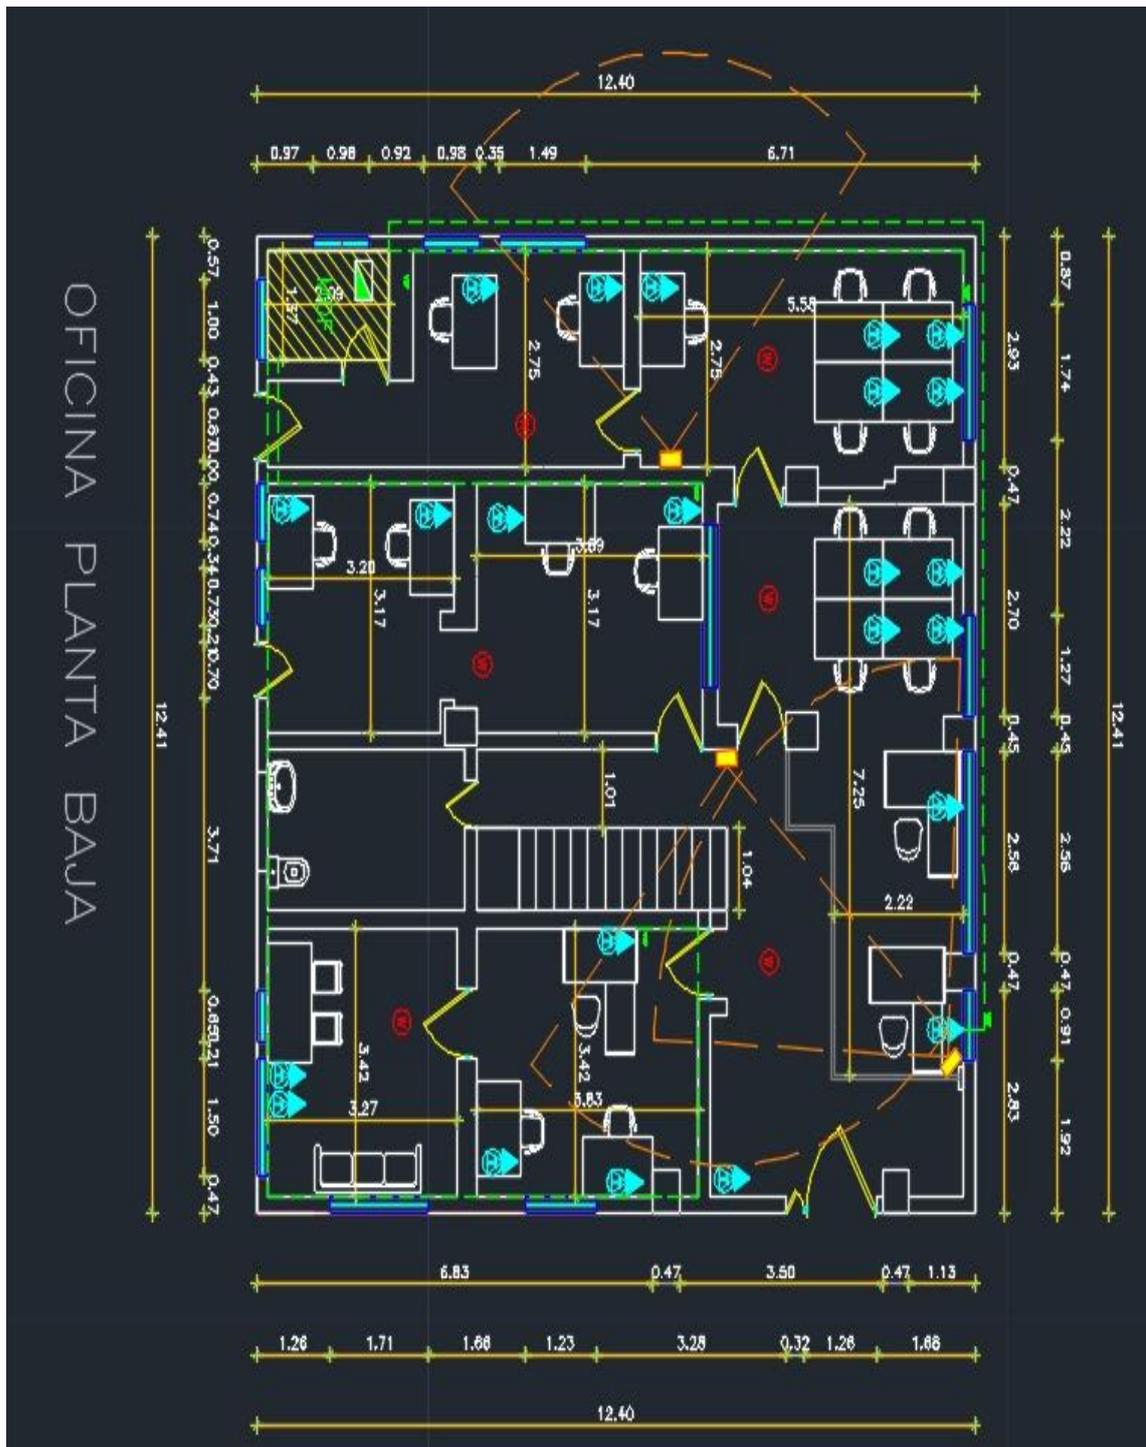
Diagrama del Rediseño Planta Baja – con medidas
